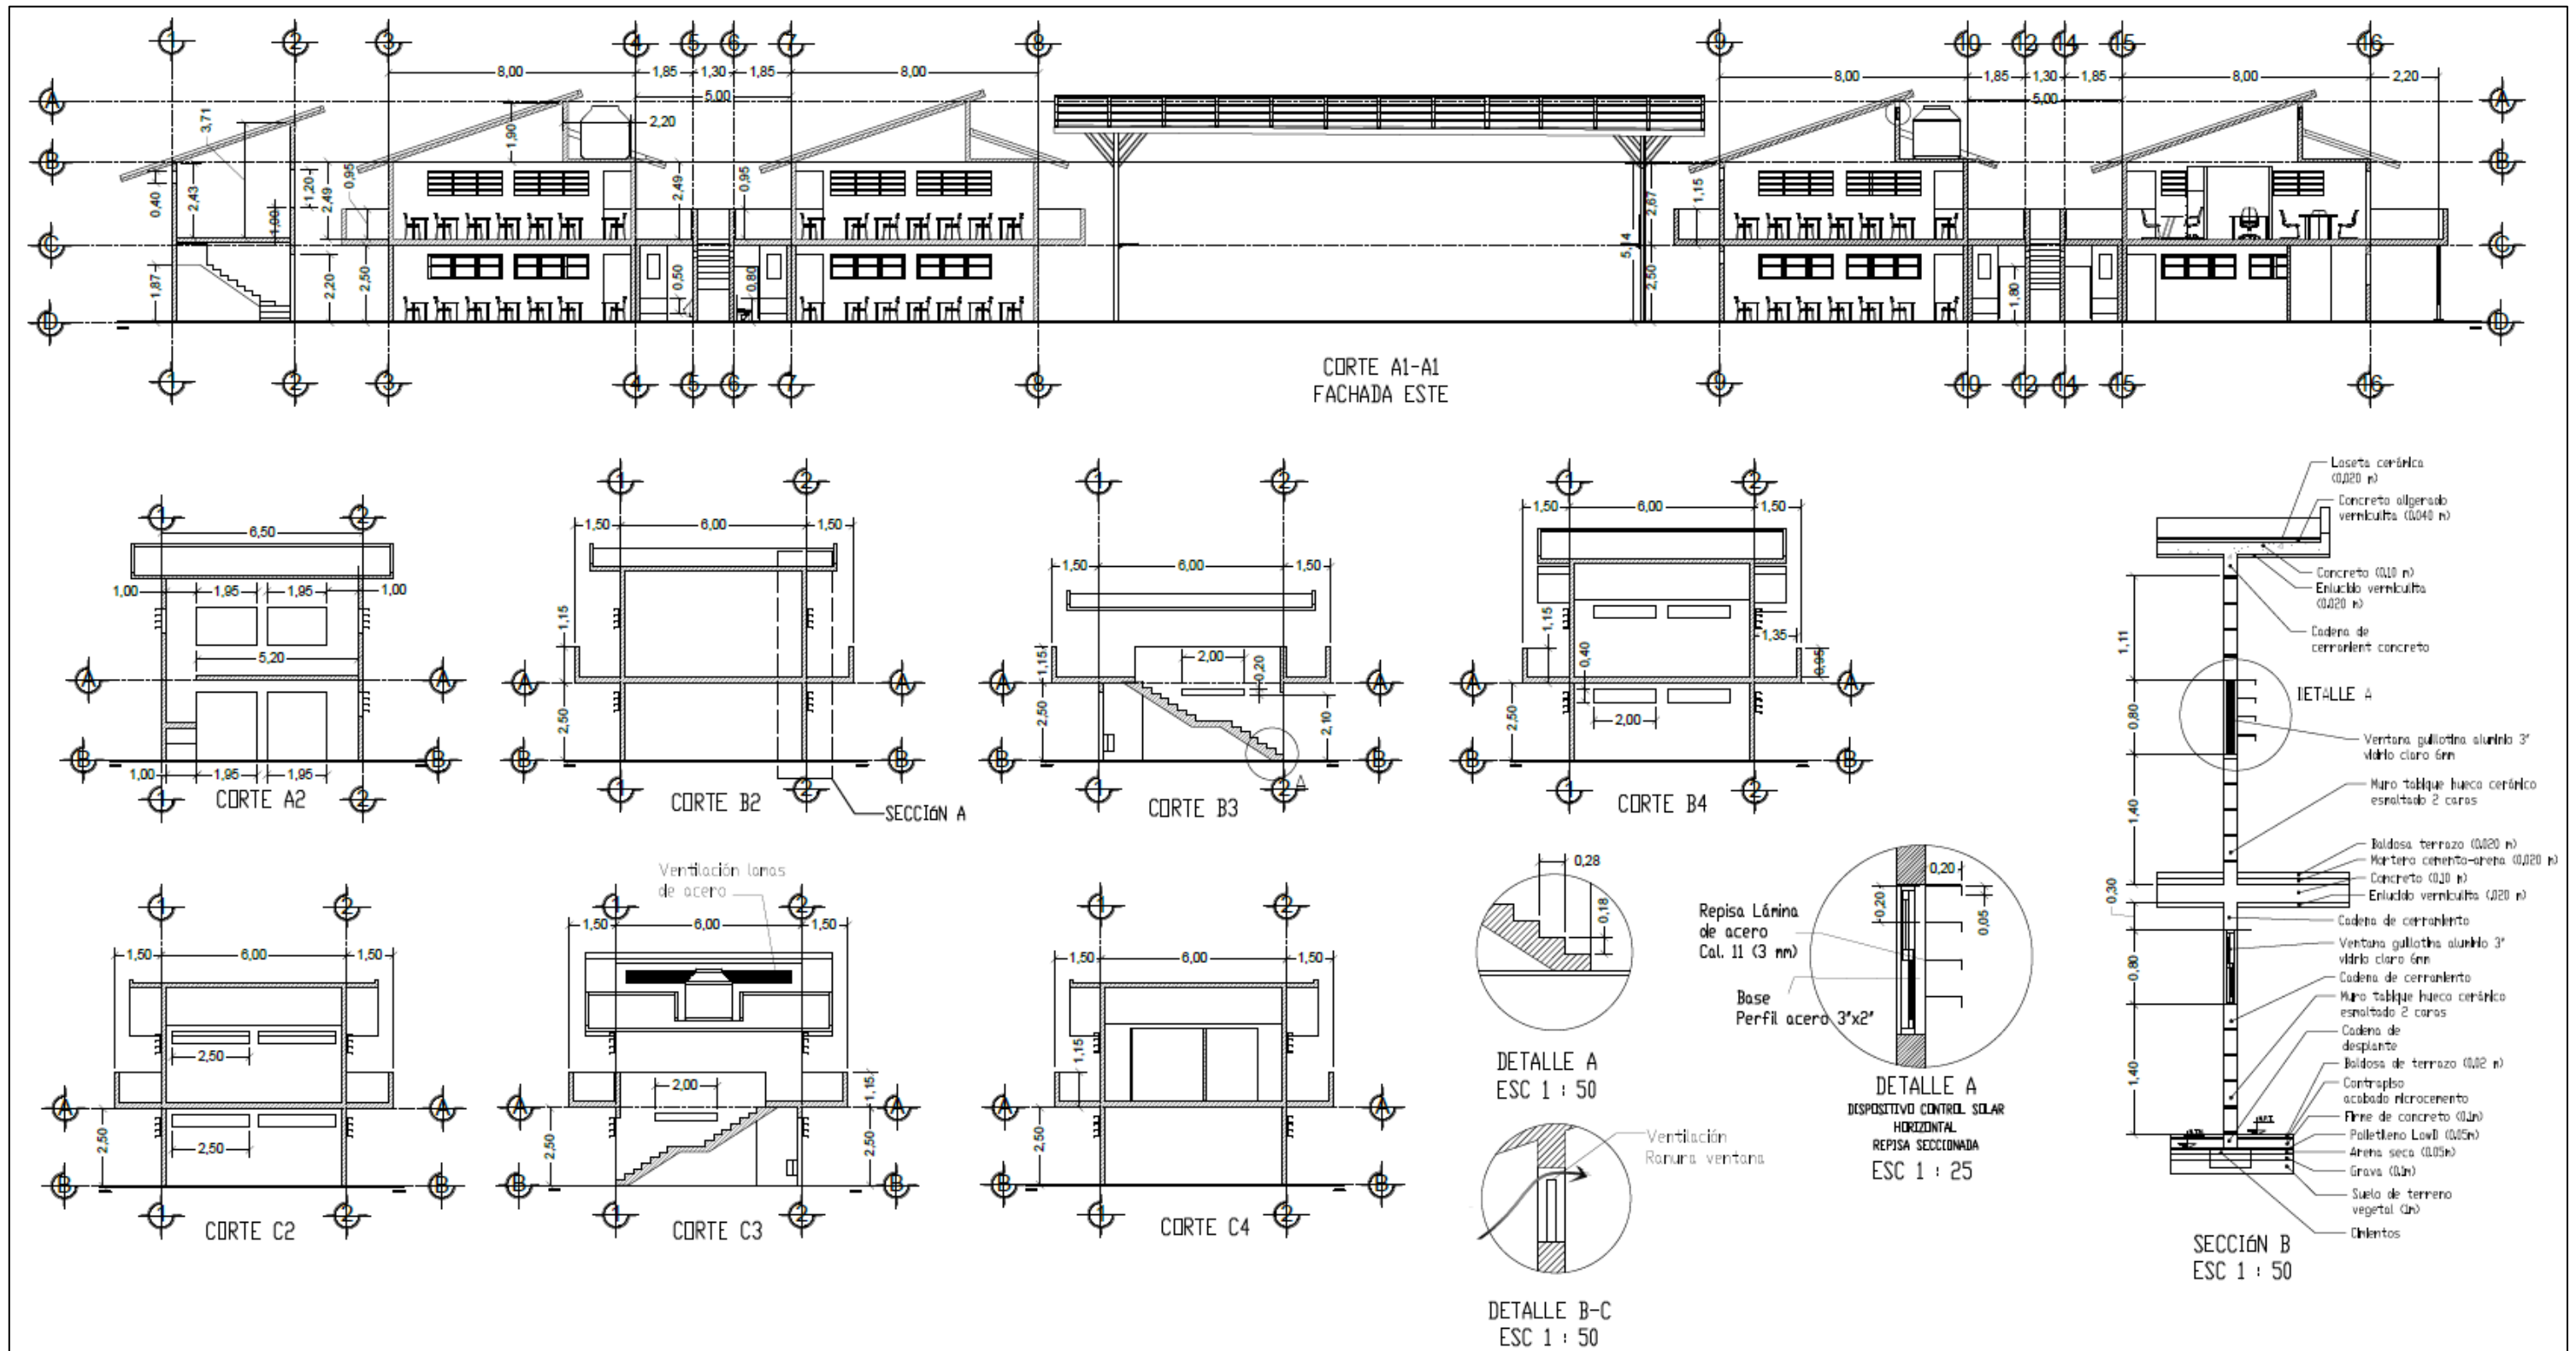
Plano-Cortes por fachada y detalles. Fuente: Elaboración propia
